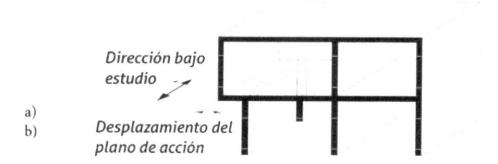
Irregularidad en planta por desplazamiento de los planos de acción.
